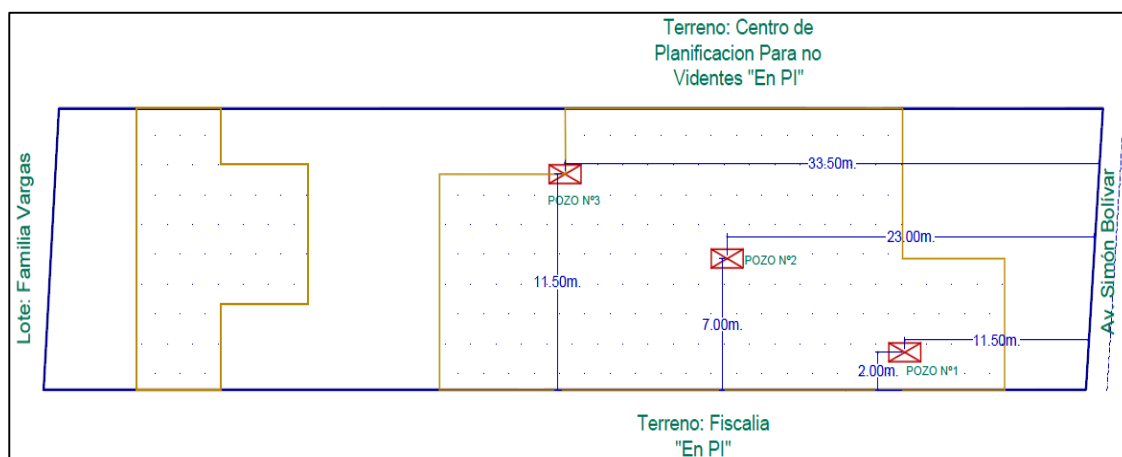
Croquis de Ubicación de los Pozos en el Terreno, Elaboración Propia.
